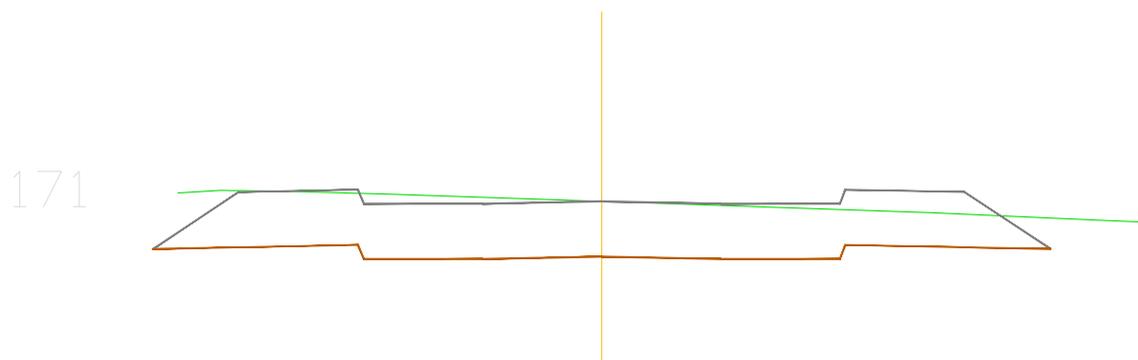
, Corte transversal del terreno modificado en el P.K. 206,086
